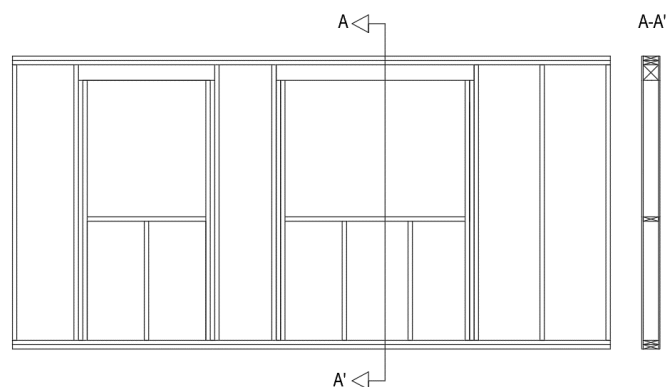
Disposição de montantes para aberturas de tamanho superior
